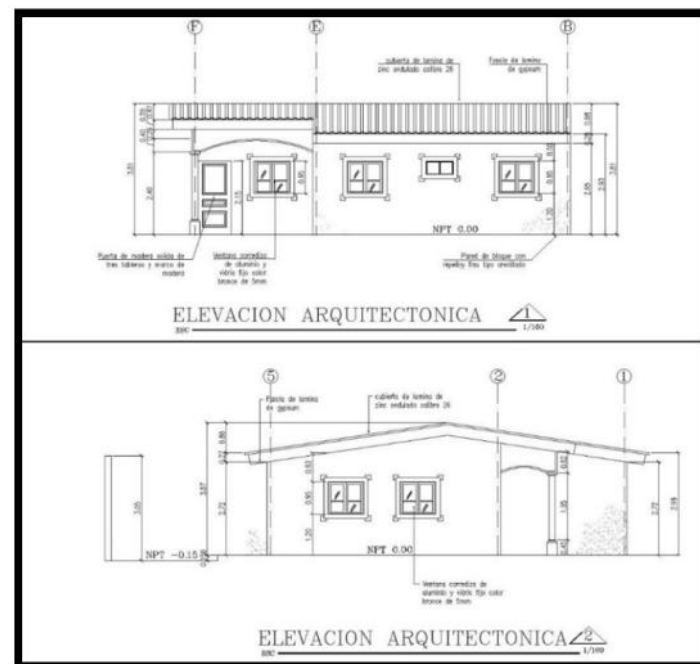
Planta arquitectónica/ elevación arquitectónica Casa Modelo
